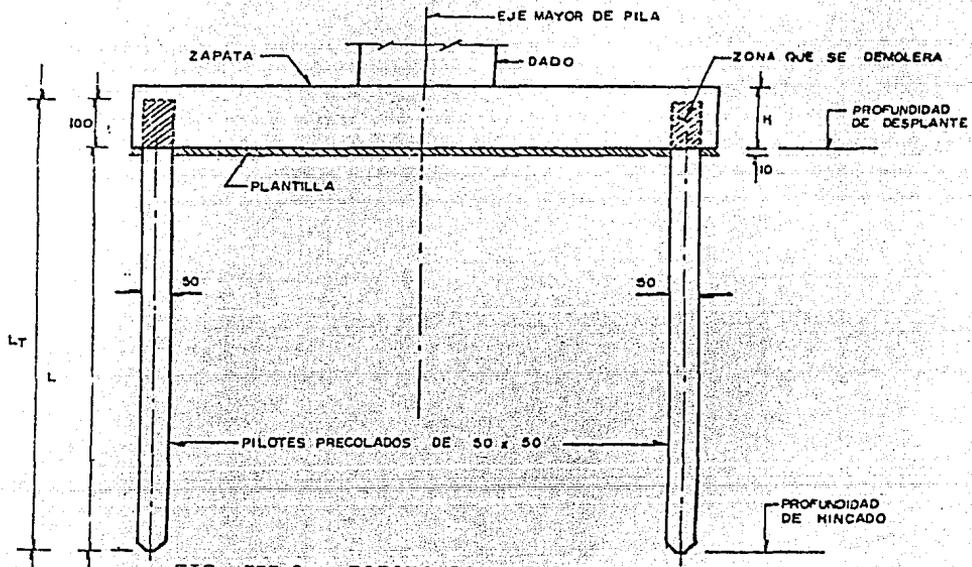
ZAPATA CON PILOTES PRECOLADOS
